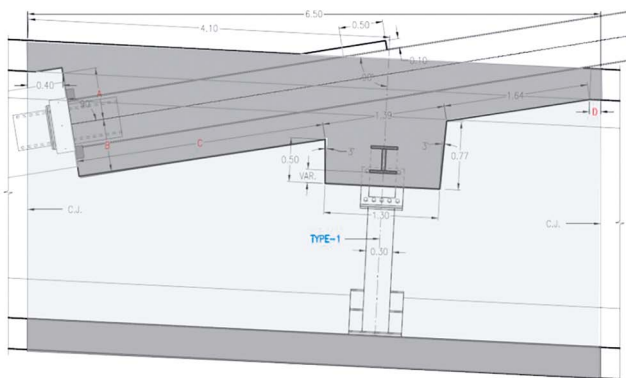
Sección longitudinal de la dovela tipo en con cable.
